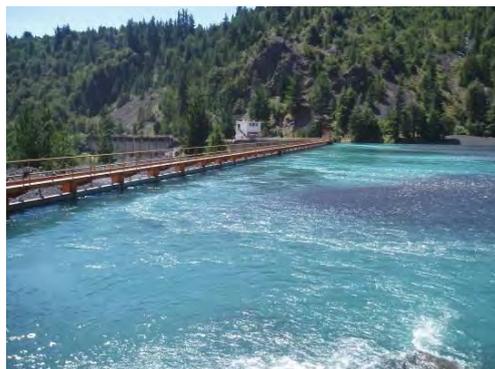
FOTO SUR PLAN FEBRERO 2007 RIO LAJA
